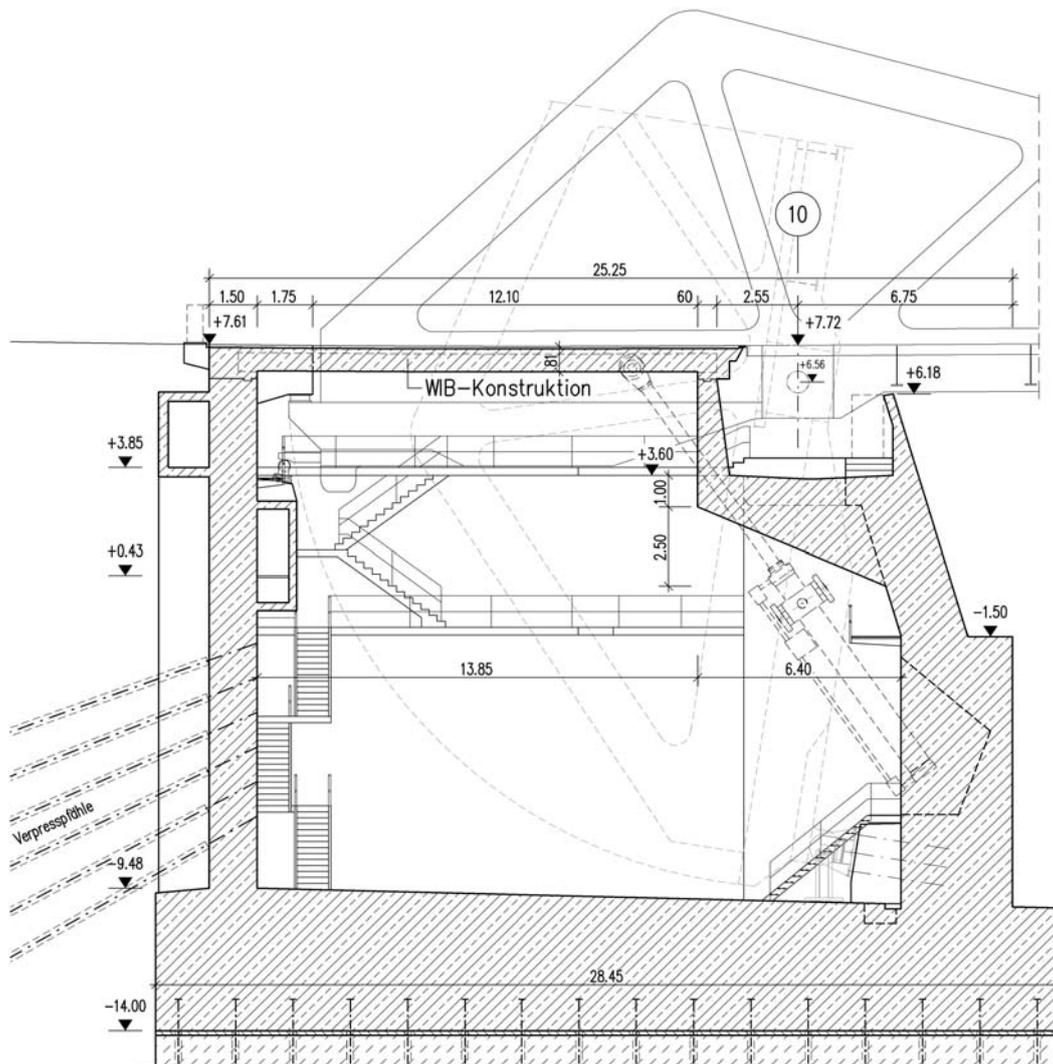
Längsschnitt Klappenpfeiler Achse 10 (Straßenbereich)
